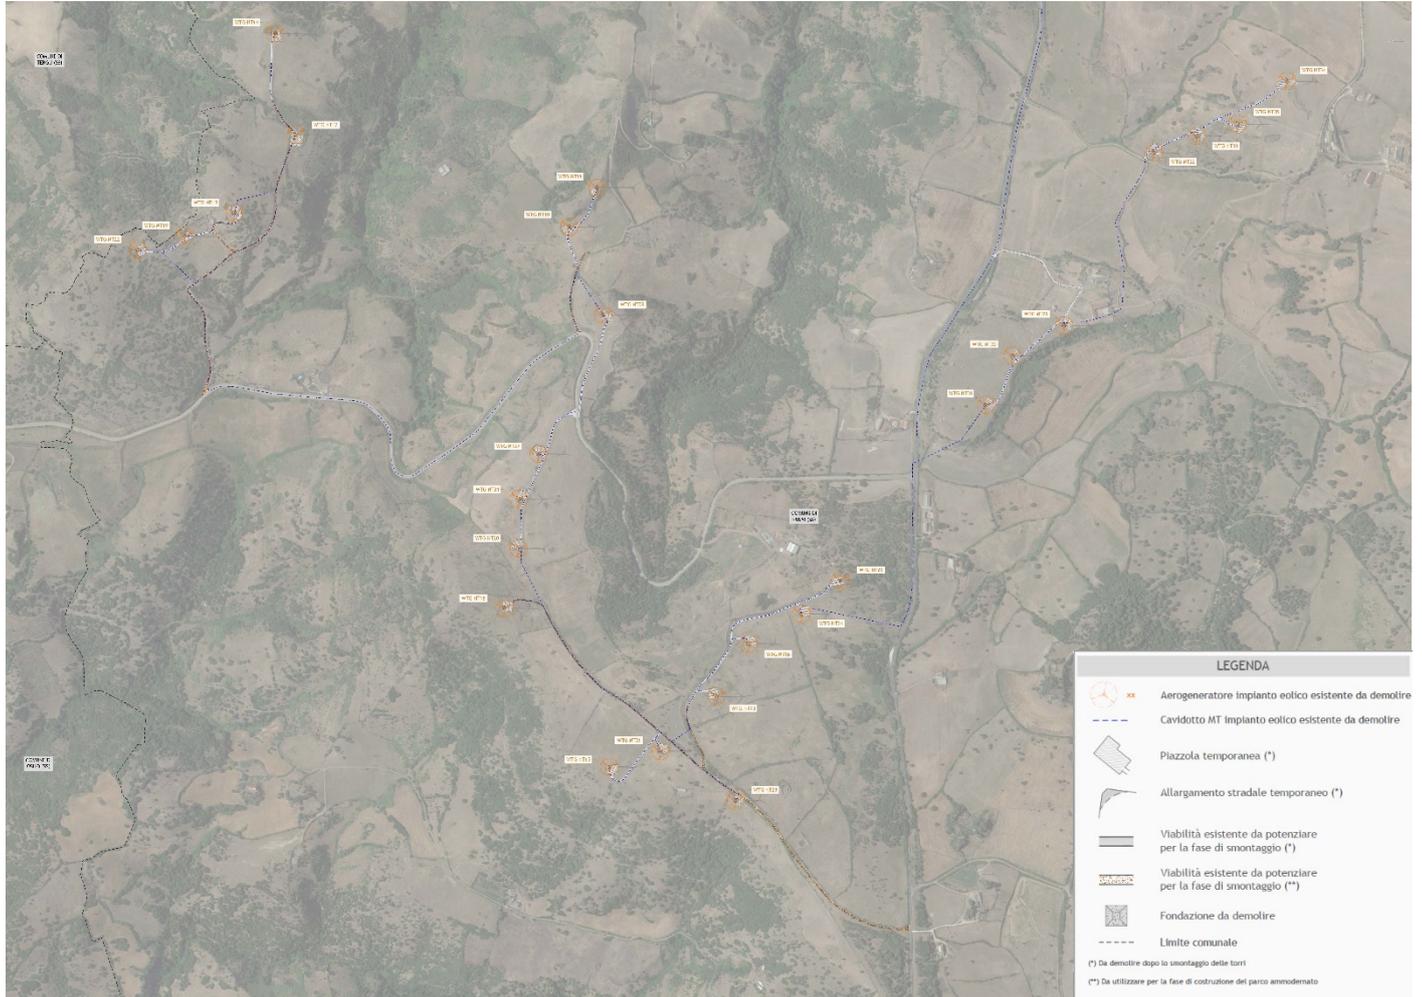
Stralcio della planimetria con individuazione dell'impianto eolico esistente su ortofoto
